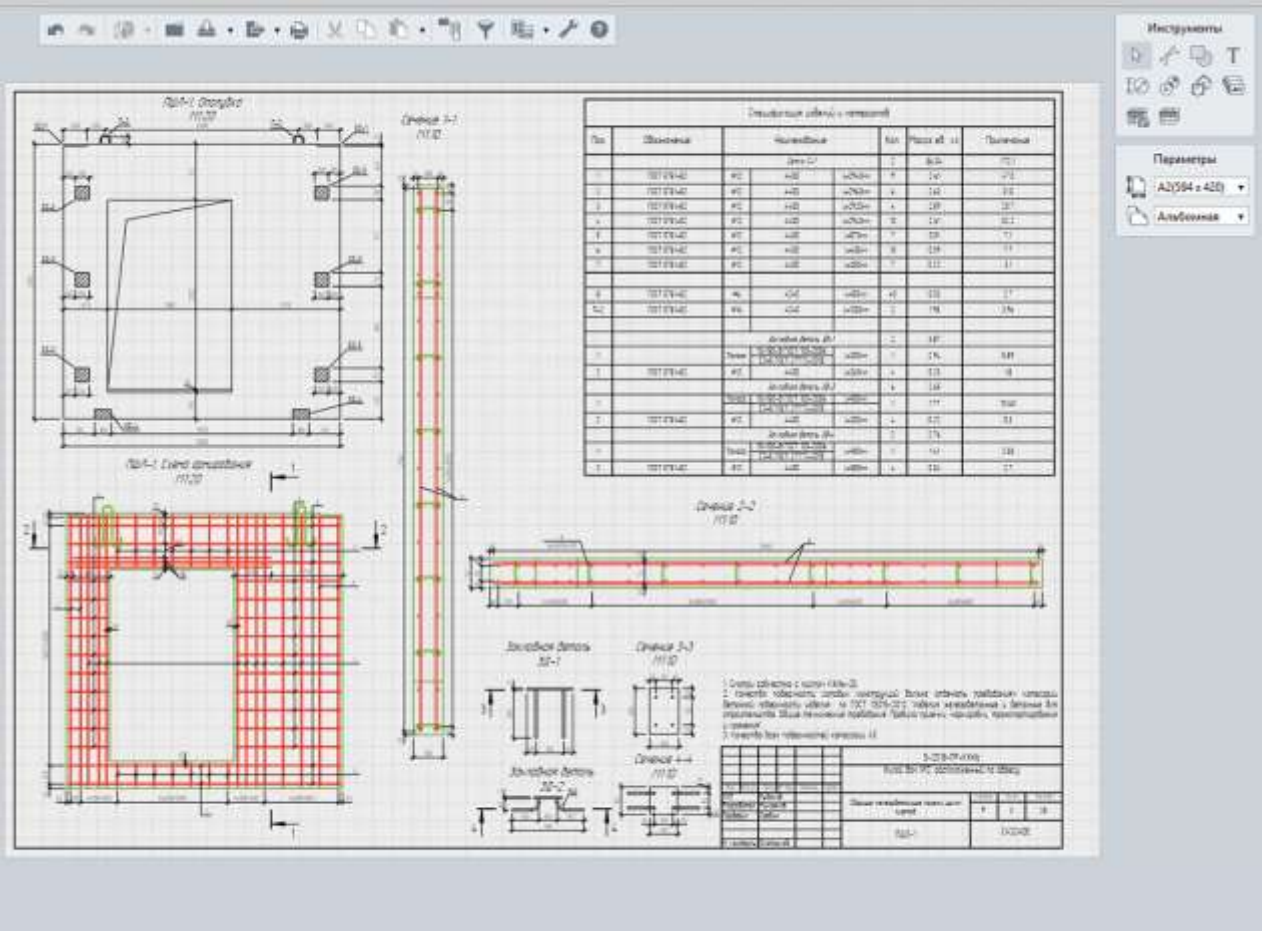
Чертеж. Готовый лист в Renga
